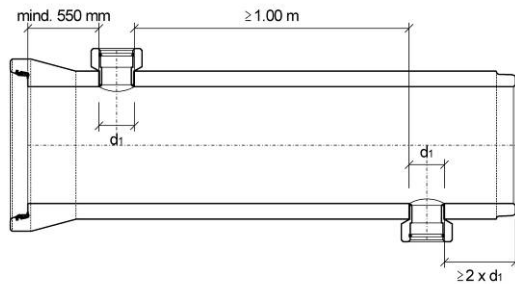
Abstände für CENTUB® Klebeanschlussstücke 90°
